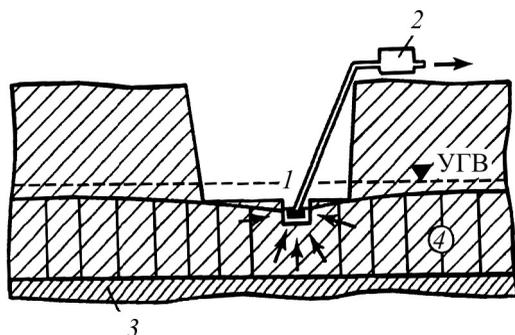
Открытый водоотлив из строительного котлована: 1 – приямок для установки всасывающего устройства откачивающего шланга; 2 – насос с водоводящим лотком; 3 – водопорный грунт; 4 – пониженный уровень грунтовых вод
